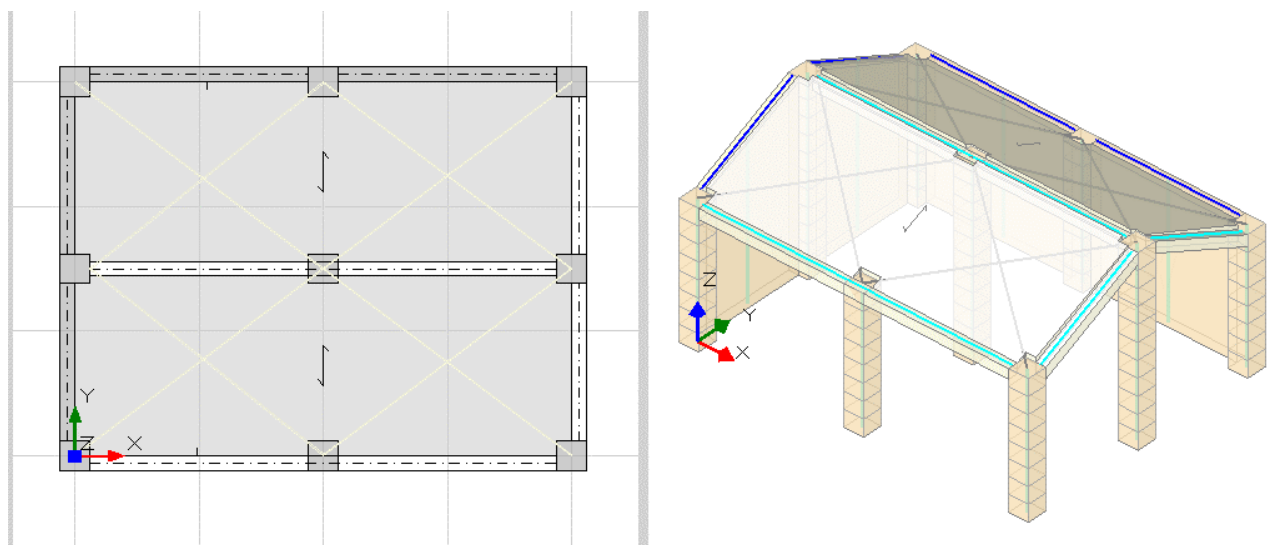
Fienile Esistente in Muratura: Vista in Pianta e Assonometria Sud-Est
